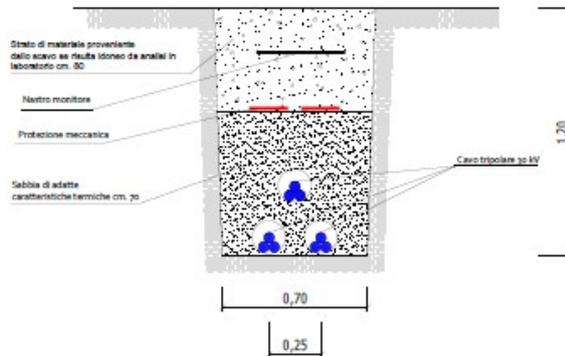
Sezione della trincea di scavo per la posa dei cavi da 30 kV di collegamento dall'impianto FV alla Stazione di Elevazione
